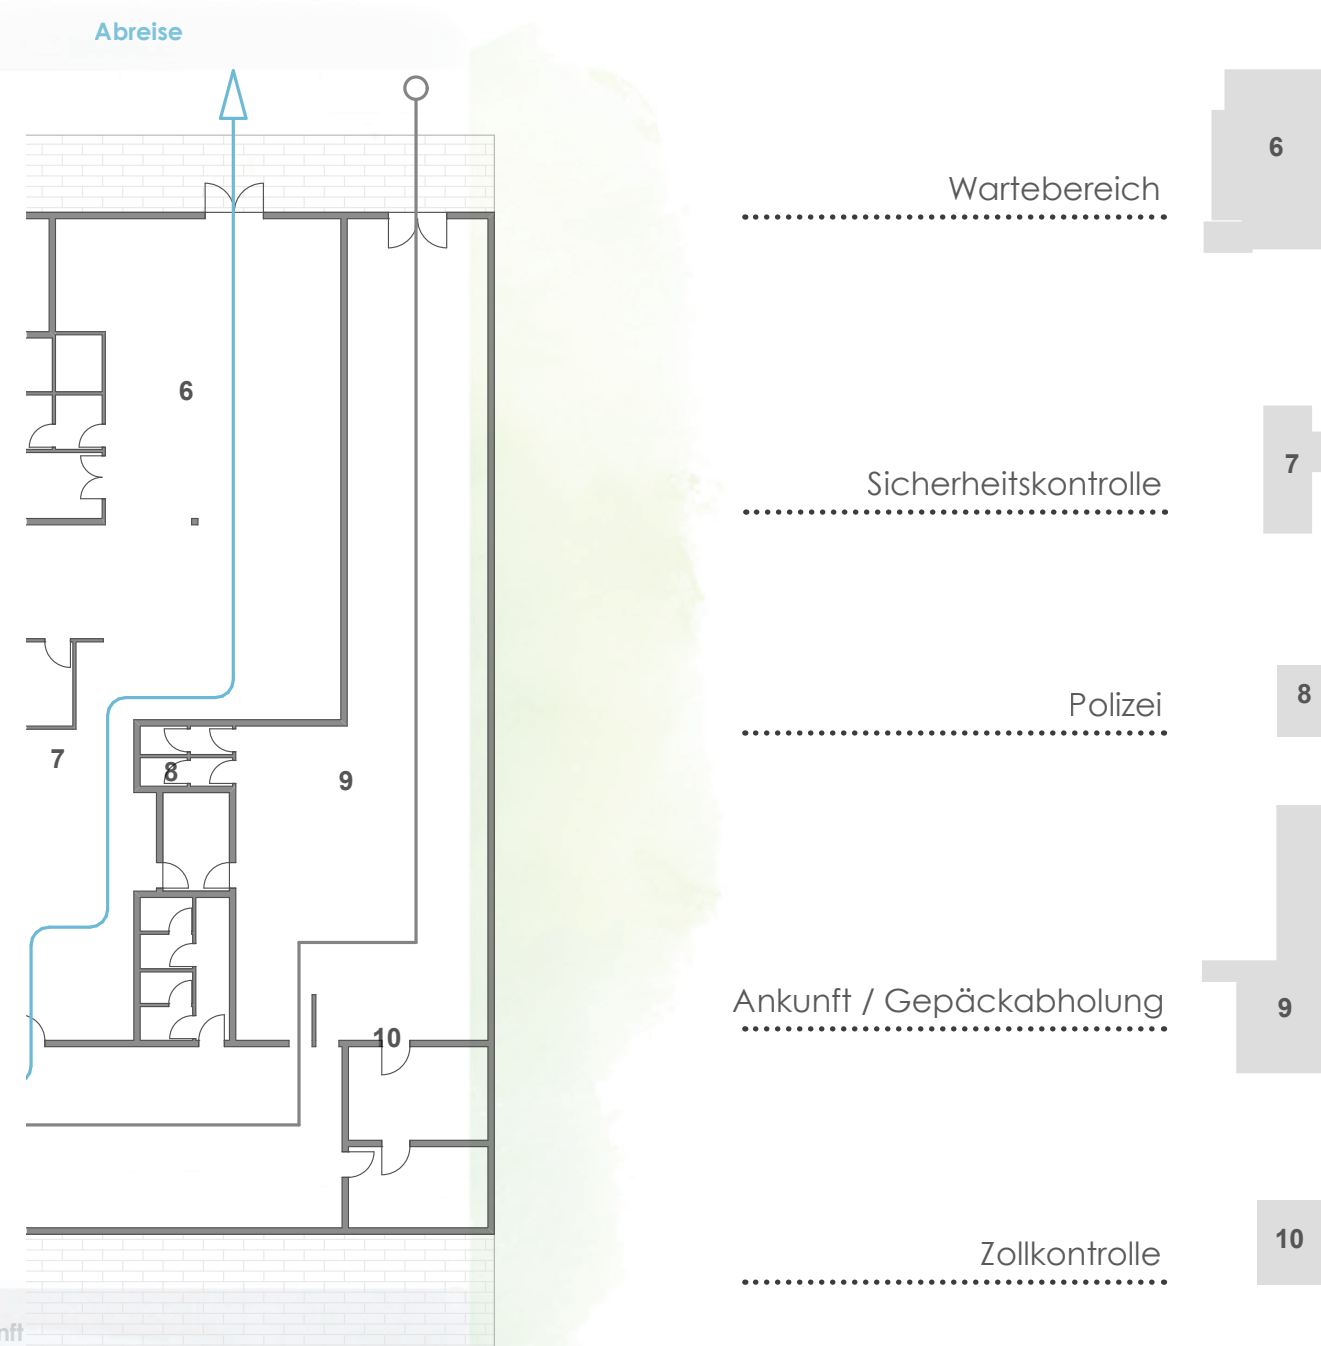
Terminalgebäude Grundriss
